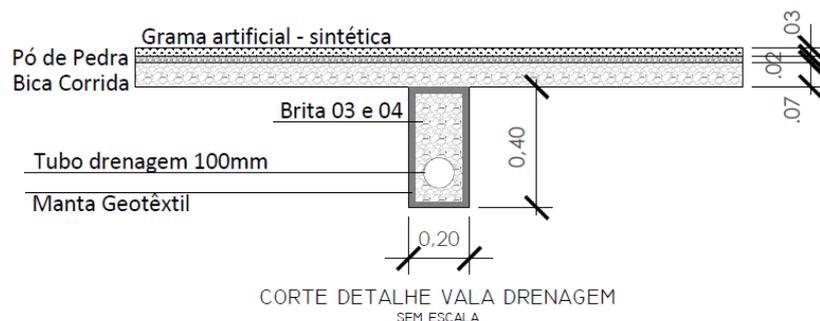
Detalhe de instalação Drenagem (Fonte: Autora/2021)
